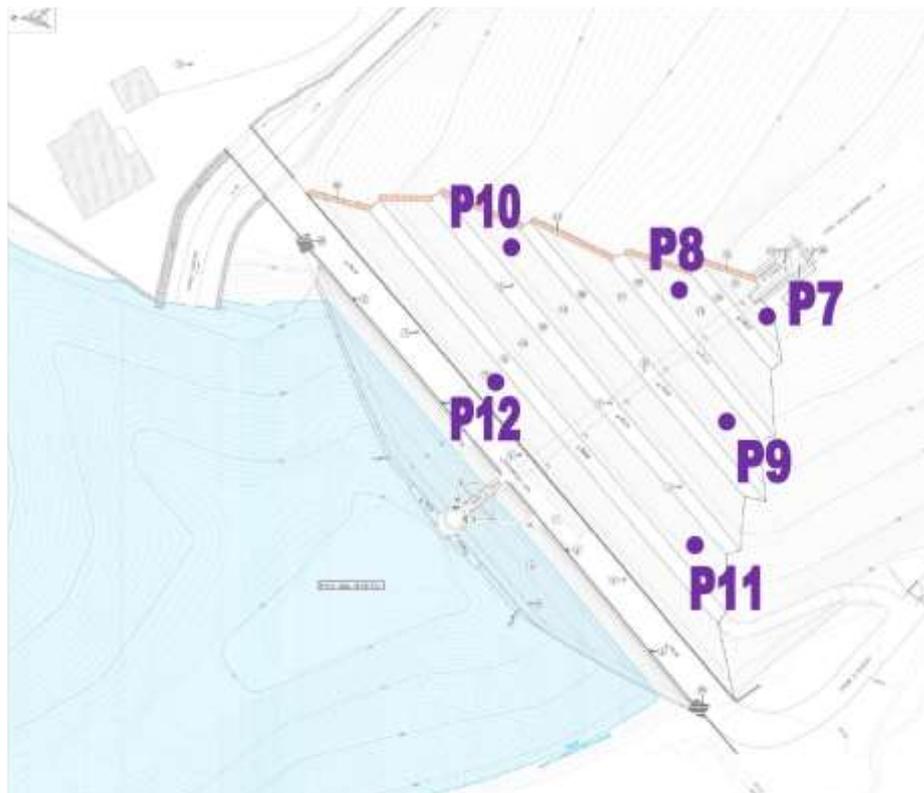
estratto planimetria ubicazione dei punti di campionamento
